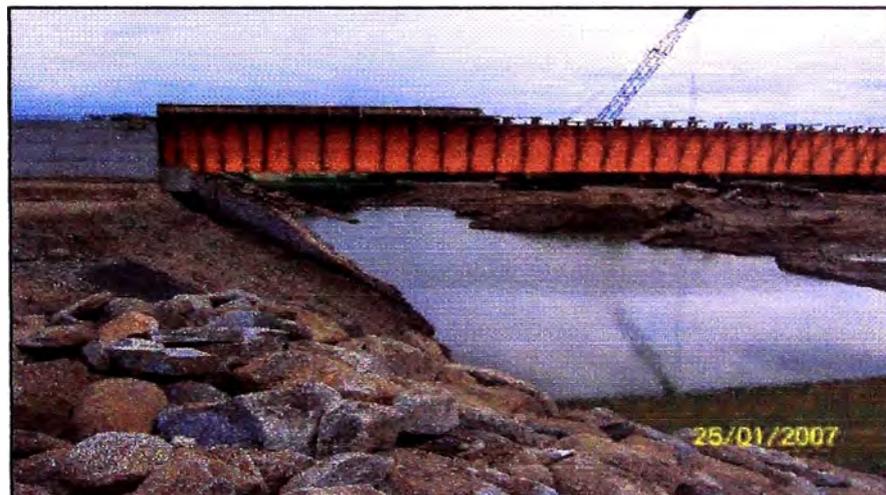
Colocación de Vigas Metálicas entre el pilar 3 y 4 .
